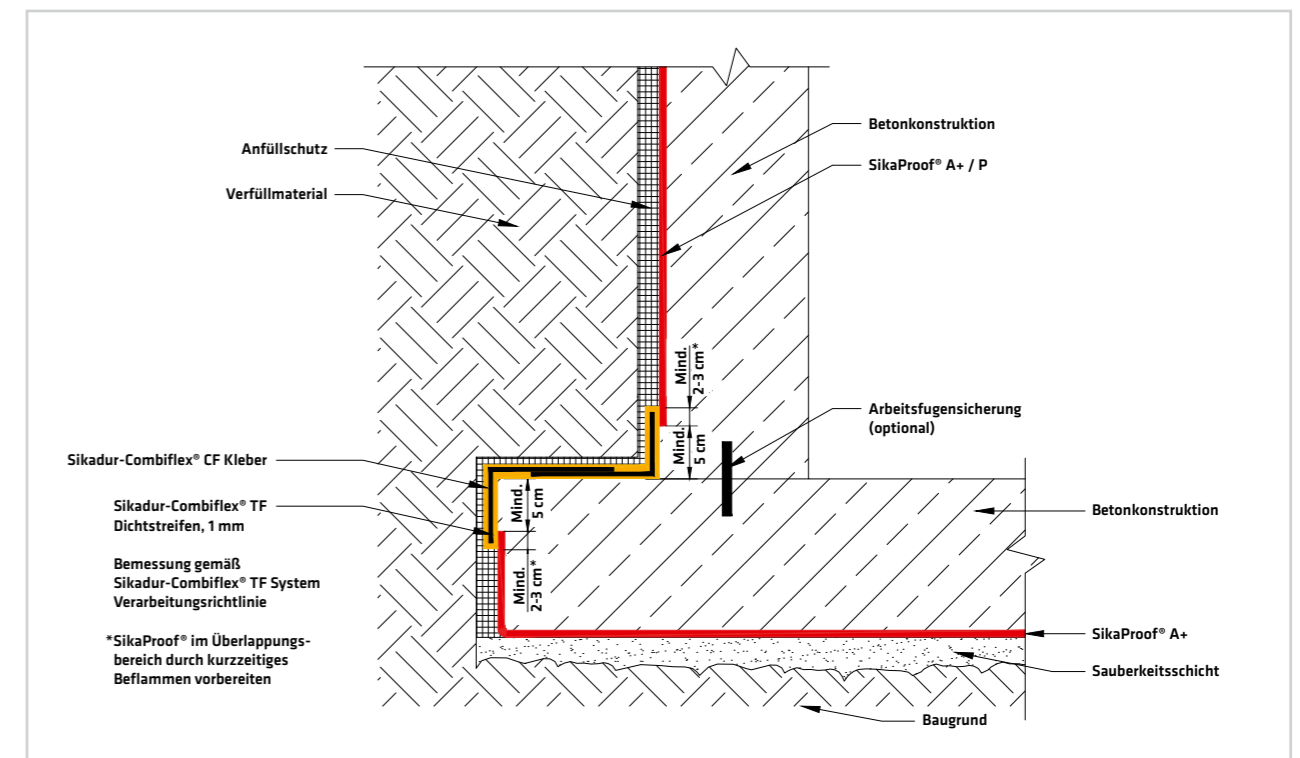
Arbeitsfuge Boden-Wand ohne Überstand mit Anschluss zu SikaProof® P
